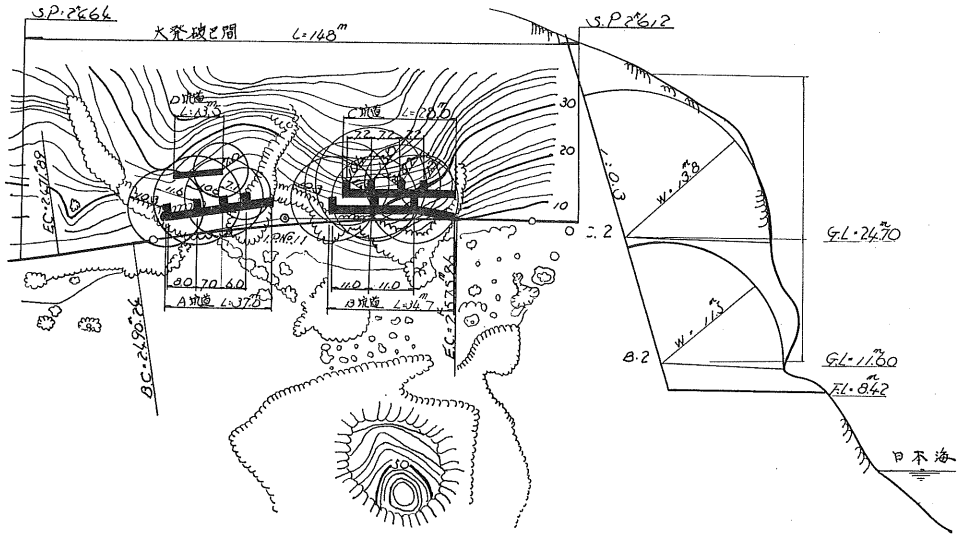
大発破支点平面図 (坑道薬室最小抵抗線)
